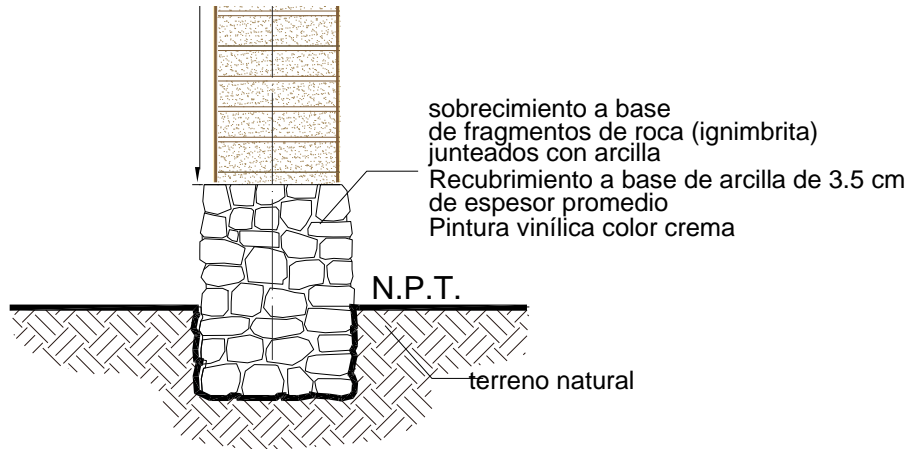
Vista del corte que muestra el sistema estructural en cimentación tentativo utilizado en la casa
